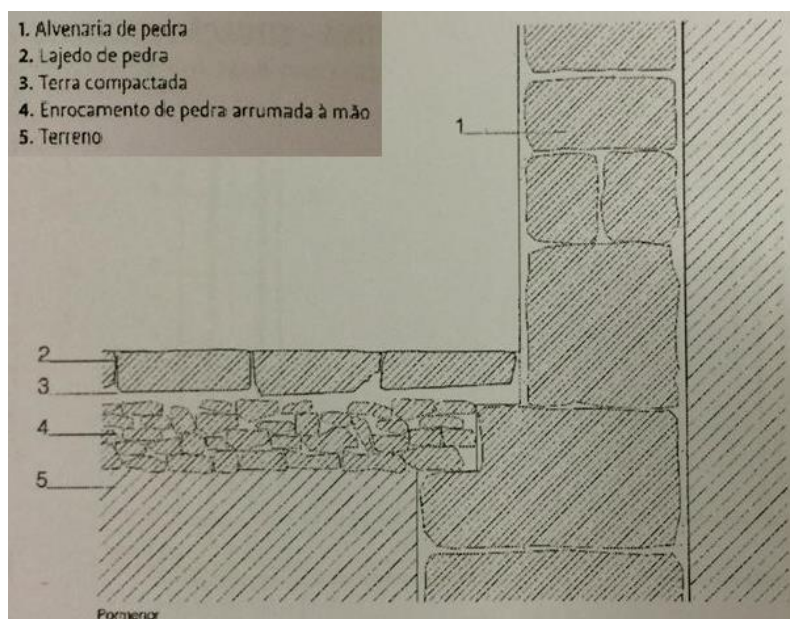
Pormenor construtivo do pavimento térreo / parede exterior [6]
